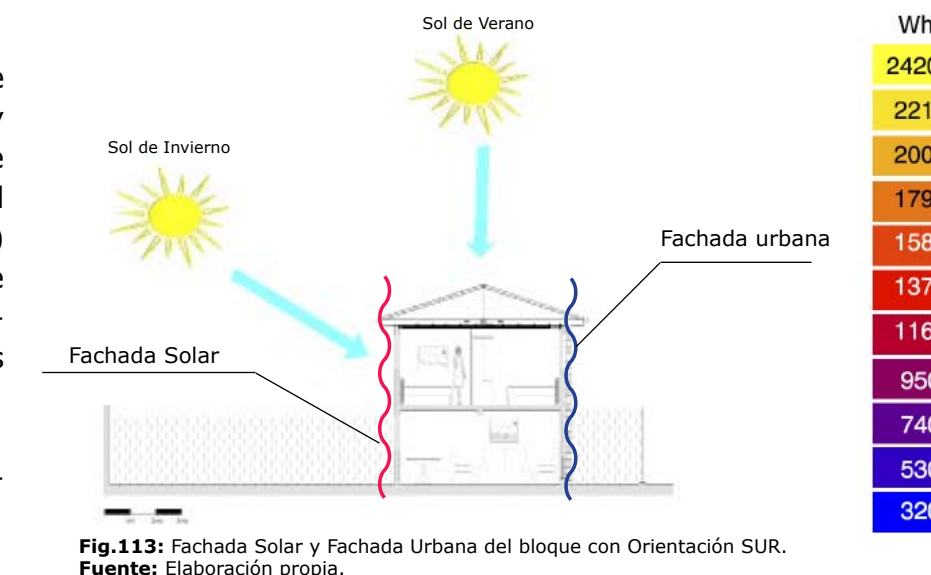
Fachada Solar y Fachada Urbana del bloque con Orientación SUR.
